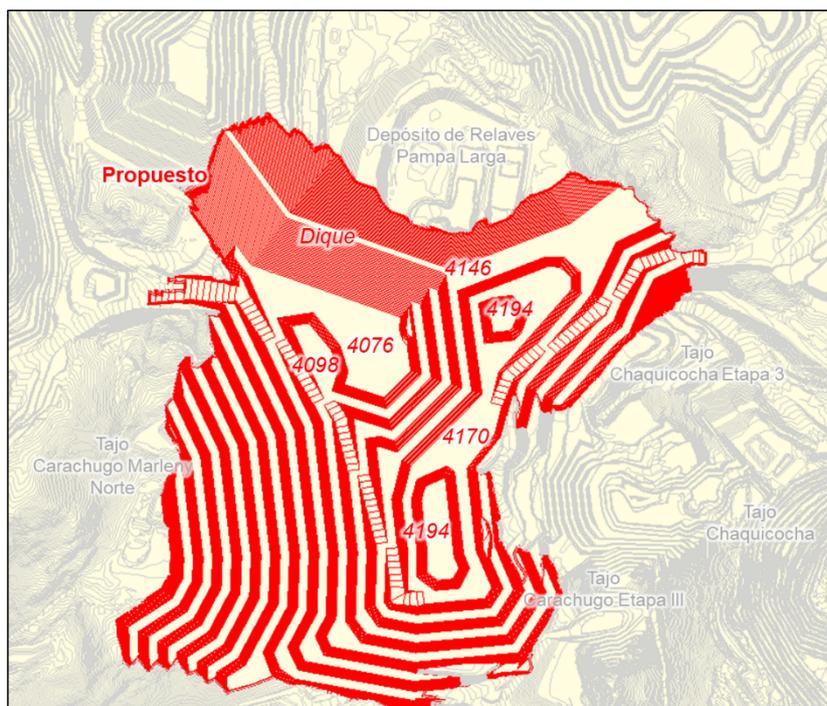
Plan de descarga del Relleno Carachugo Etapa 3 - Año 2028 – Vista en planta
